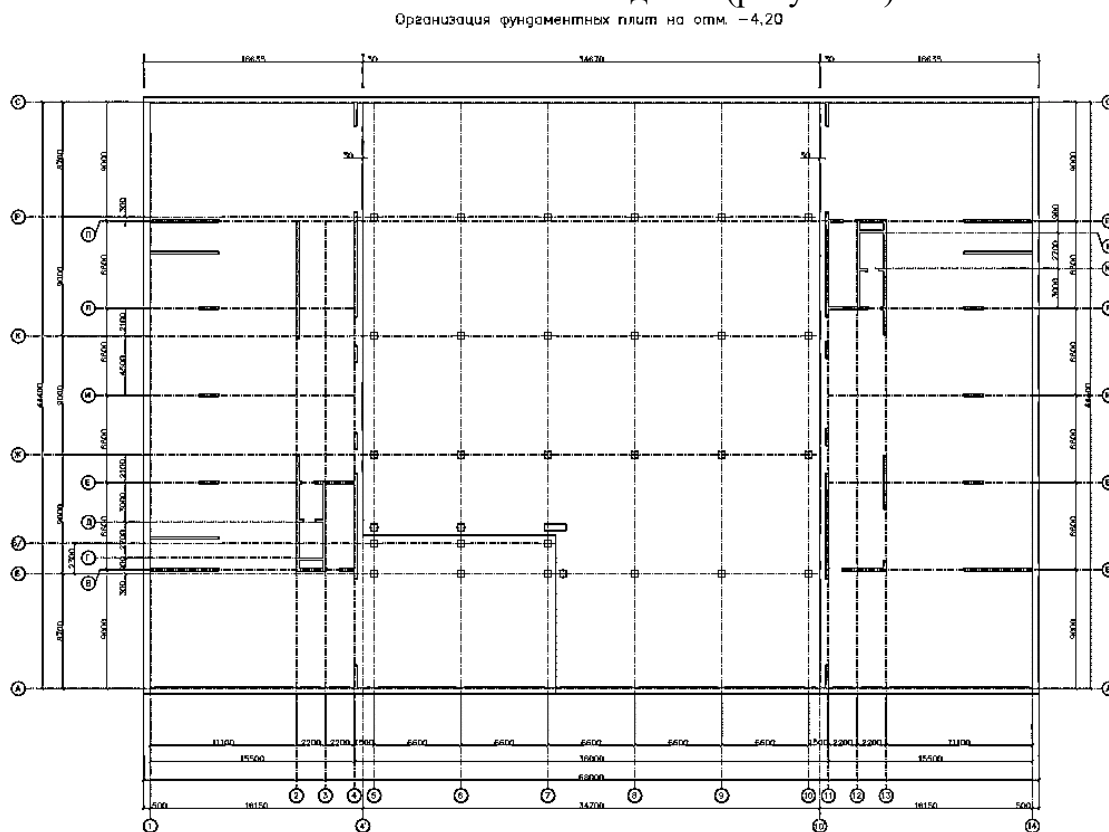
Чертеж организация фундаментных плит на отметке -4.200
